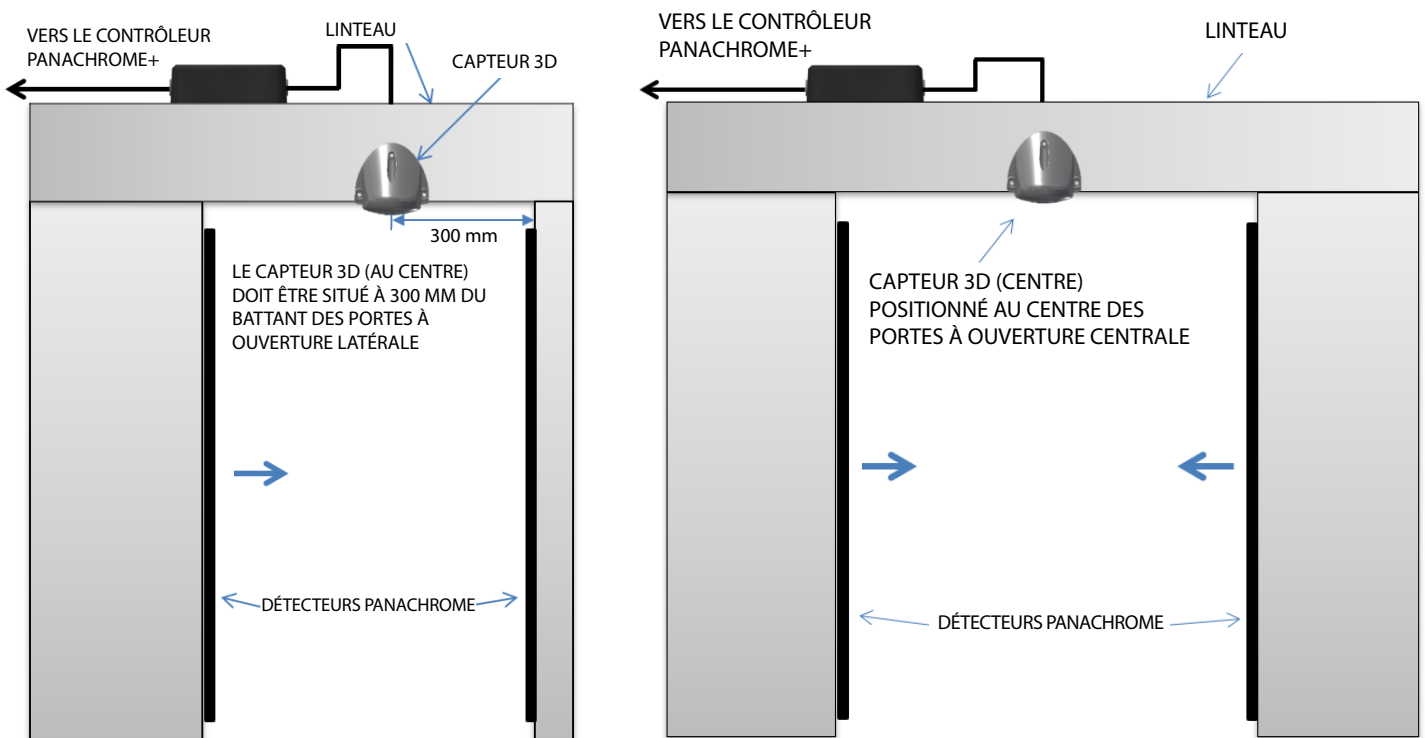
Montage du capteur 3D dans les installations à ouverture centrale et latérale
